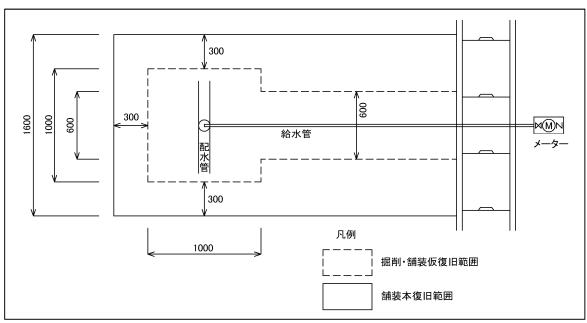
掘削(舗装仮復旧)及び舗装本復旧 標準平面図
